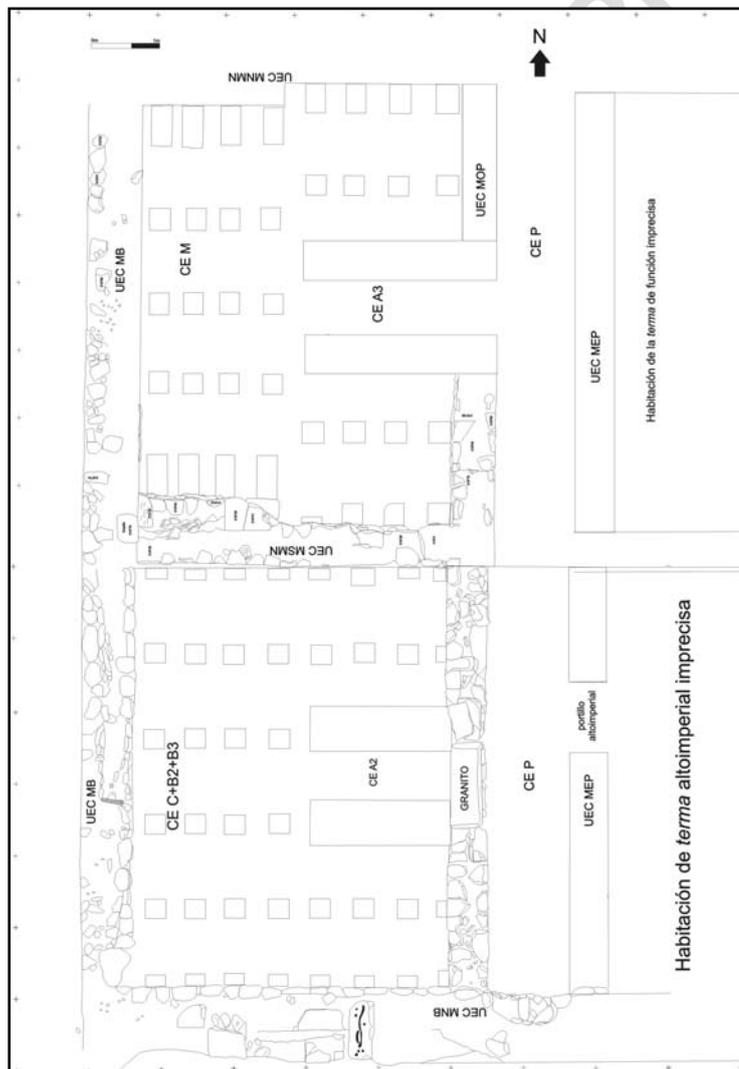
Planta del *hypocaustum* en la fase alto-imperial
